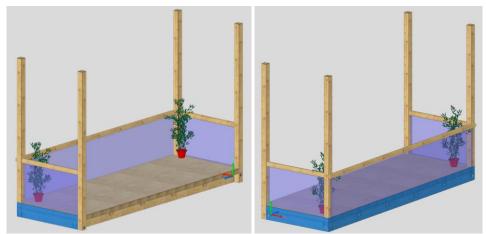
Alternativa 3 – balcón colgado desde alero de cubierta
